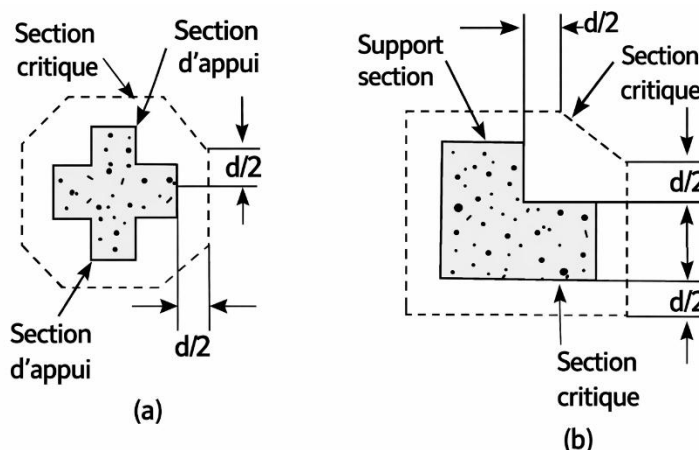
Section critique pour les sections de poteaux avec des angles entrants [3]
